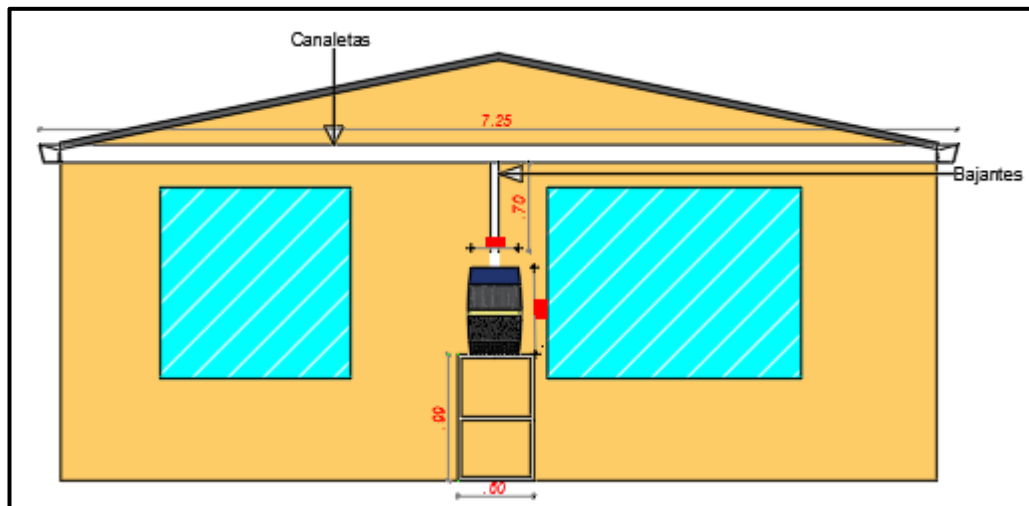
Vista Posterior Casa Tipo y Sistema de Conducción
